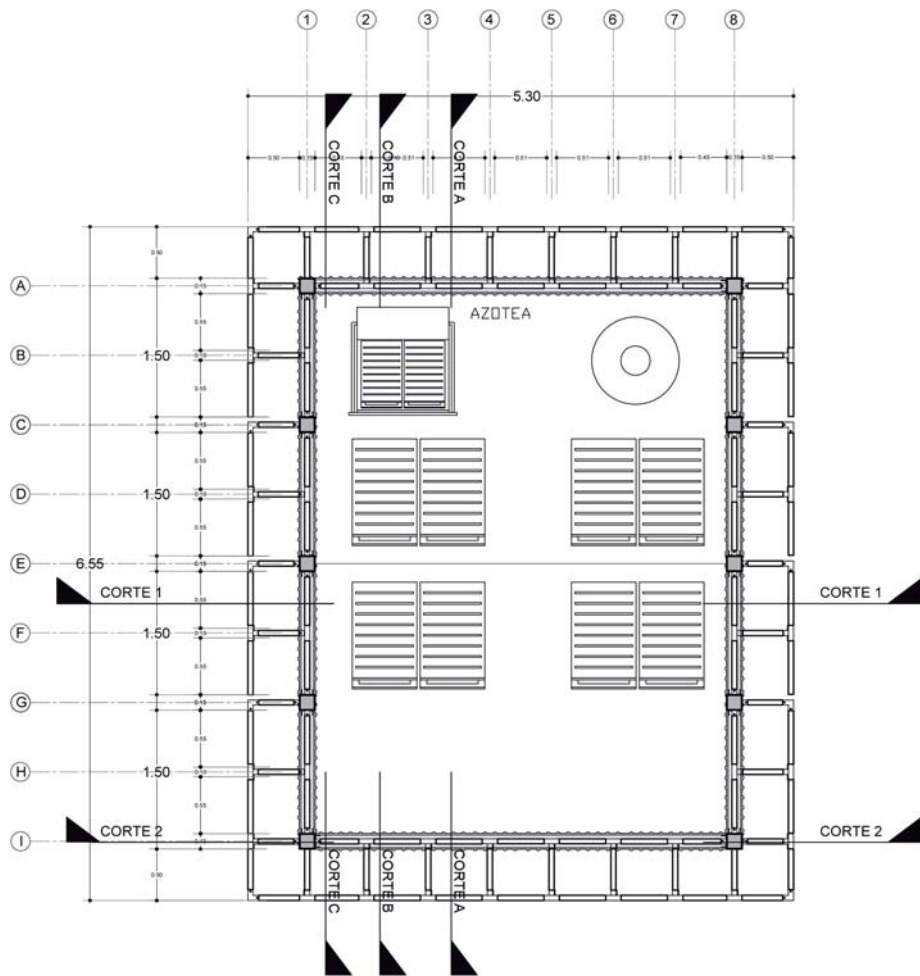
Nelly Hernandez (2018) Planta arquitectónica (plano).
